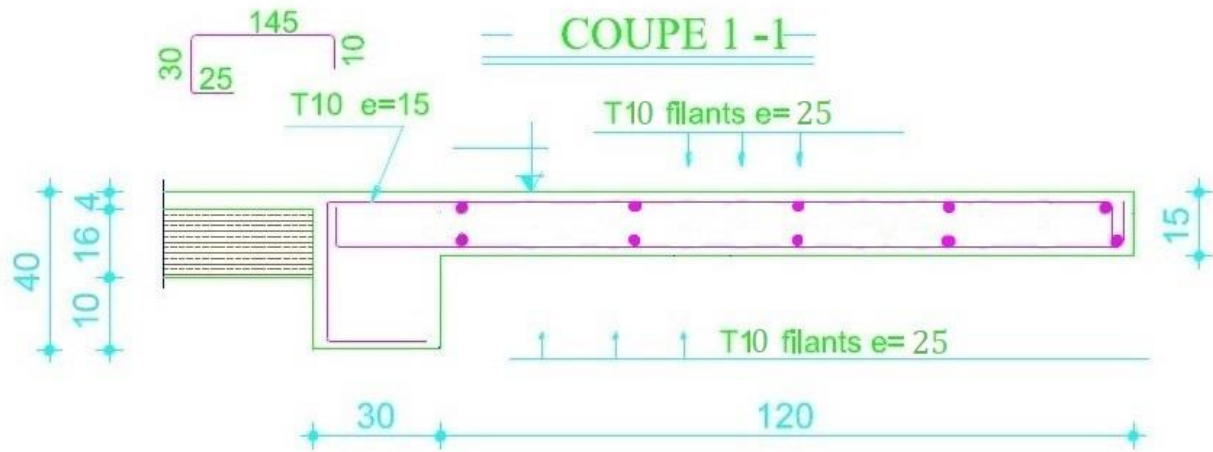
4 : Dessin du ferrailage du balcon.
